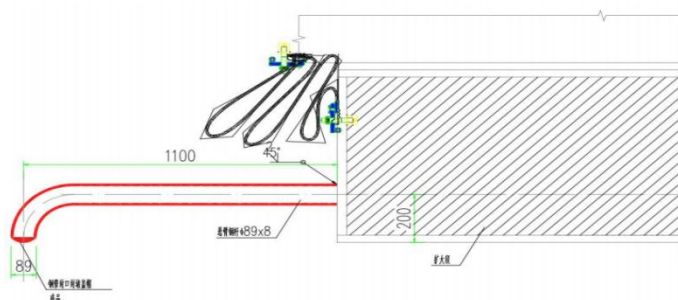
M 型止水带防下垂装置断面图 (单位: mm)
